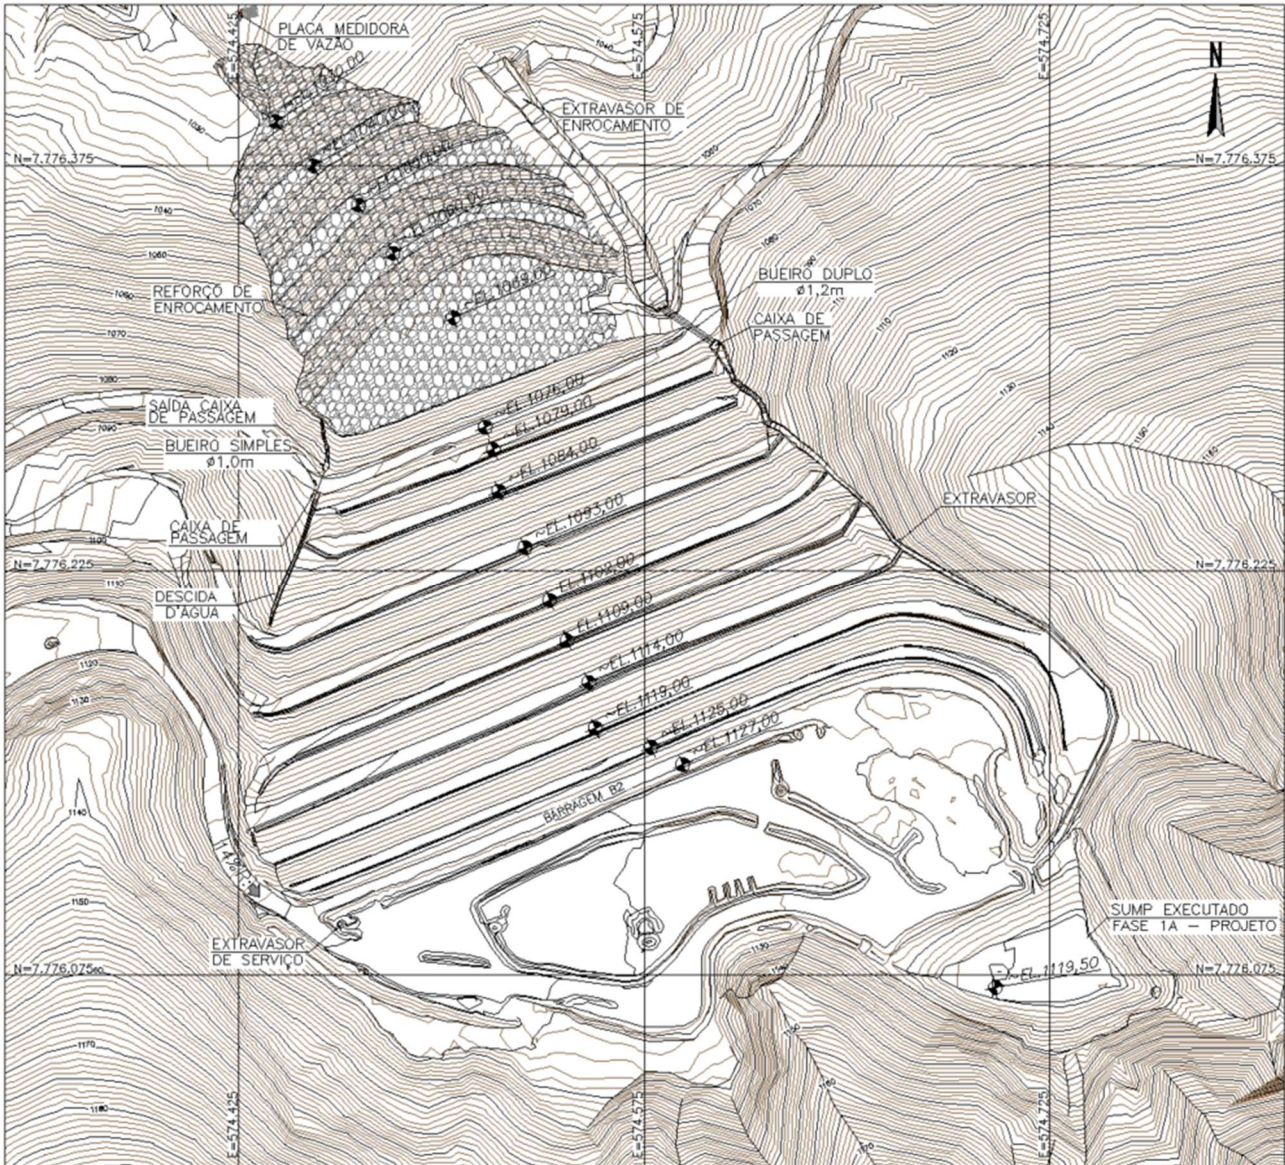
Levantamento topográfico 01/08/24 – Obras Executadas - Planta – Fase 1A.
